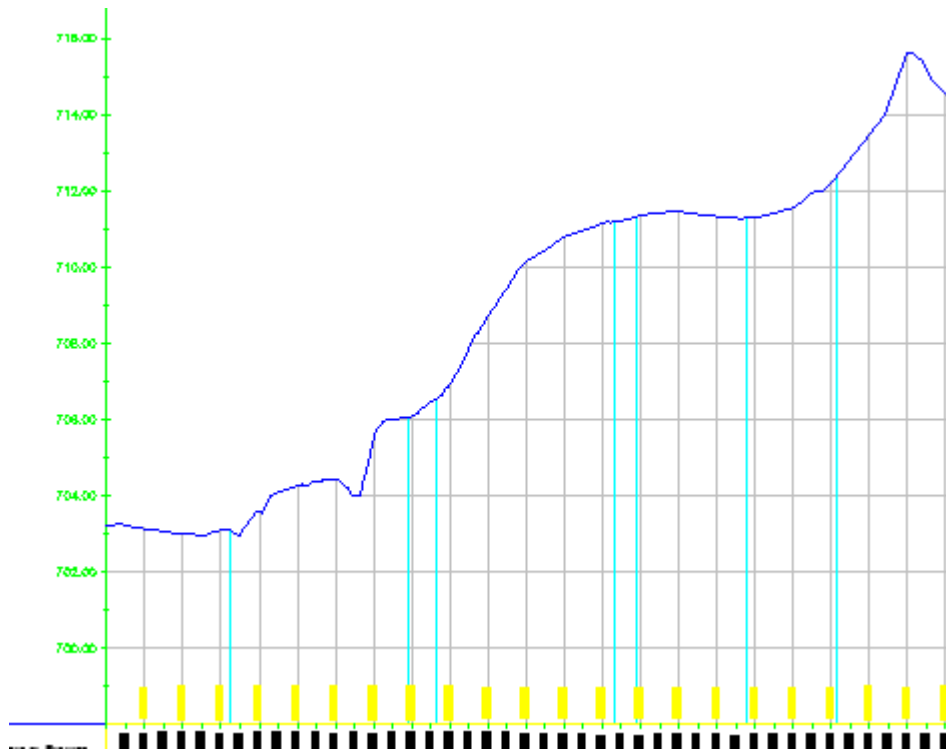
Perfil Longitudinal do terreno – Ramo D
